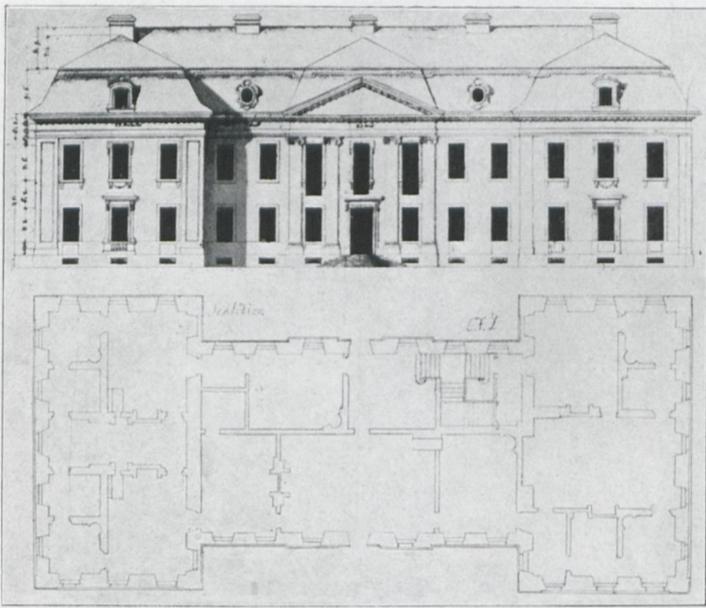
Carl Florus zu Dohna-Schlodien, Aufrissvarianten der Zufahrtsseite von Schloss Schlodien und Grundriss des Erdgeschosses. Kopie nach einem Plan von Jean de Bodt (um 1701), lavierte Federzeichnung, nach 1710 (ehem. Schlodien, Archiv; heute verschollen)
